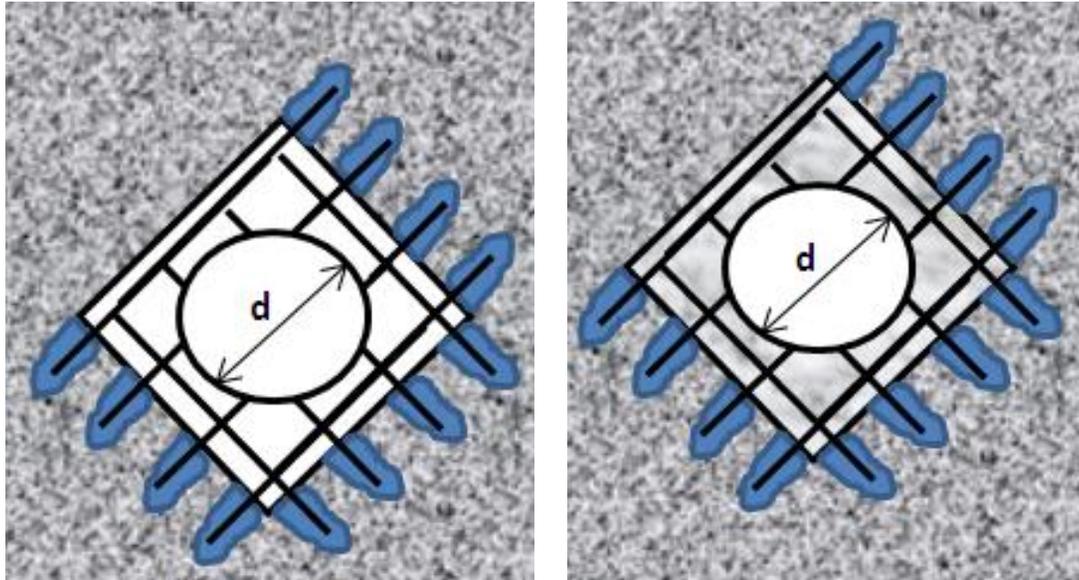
Posicionamiento de anclajes y de tubería embebida. Relleno con concreto fluido
